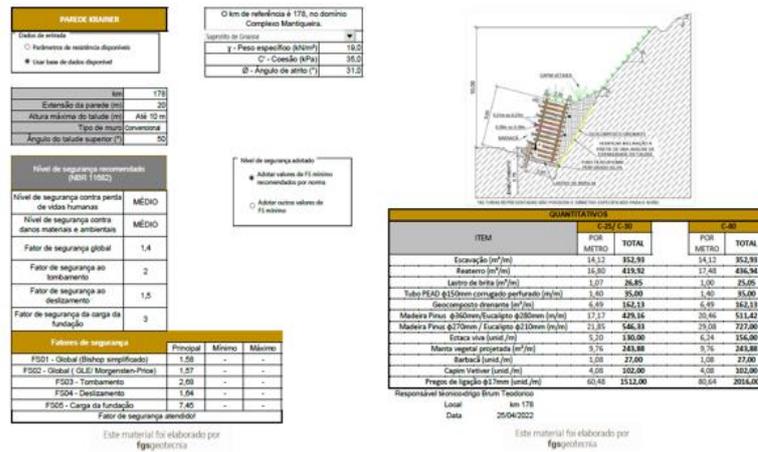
Planilha de cálculo de estrutura de contenção tipo parede Krainer.
